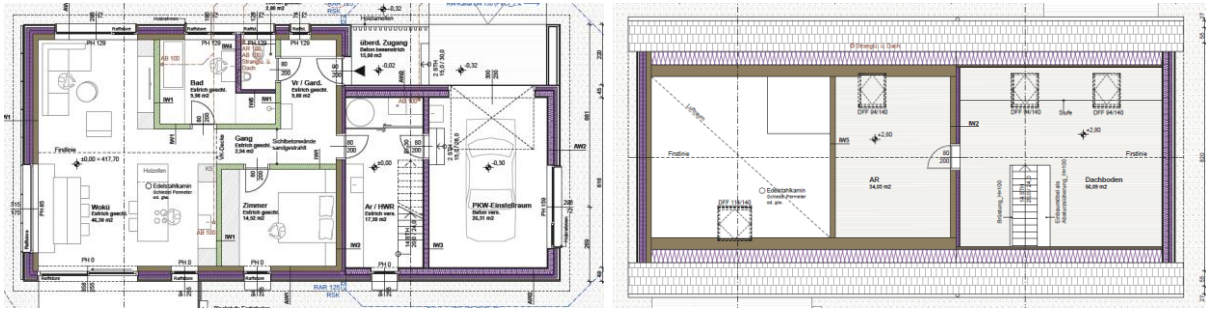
Grundriss EG (links) und Grundriss DG (rechts) des Solarhauses Anzberger (Quelle: Einreichplan)
